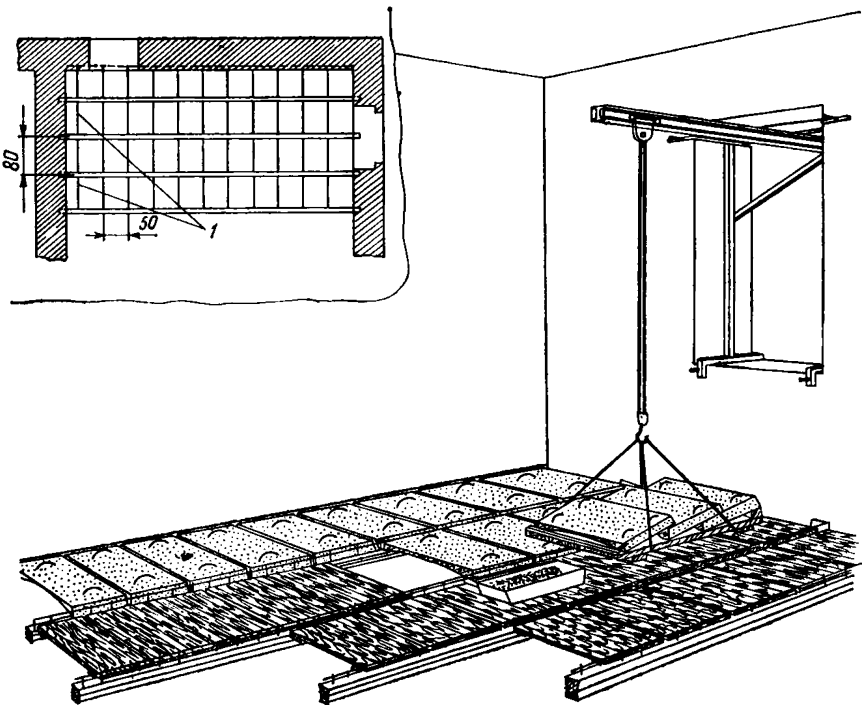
Общая схема организации работ по устройству сборно-монолитного перекрытия
